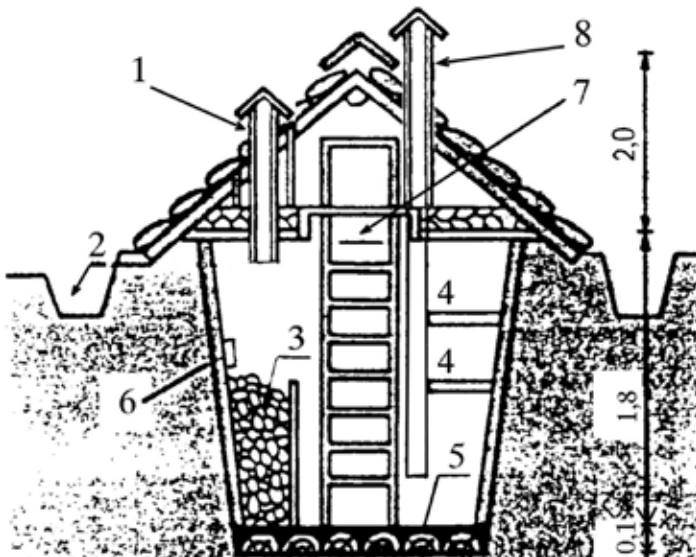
Земляной погреб. 1 – вытяжной вентиляционный воздуховод; 2 – обводная канавка; 3 – ёмкость для картофеля; 4 – полки для размещения разных продуктов; 5 – пол; 6 – термометр; 7 – лестница; 8 – приточный воздуховод.
